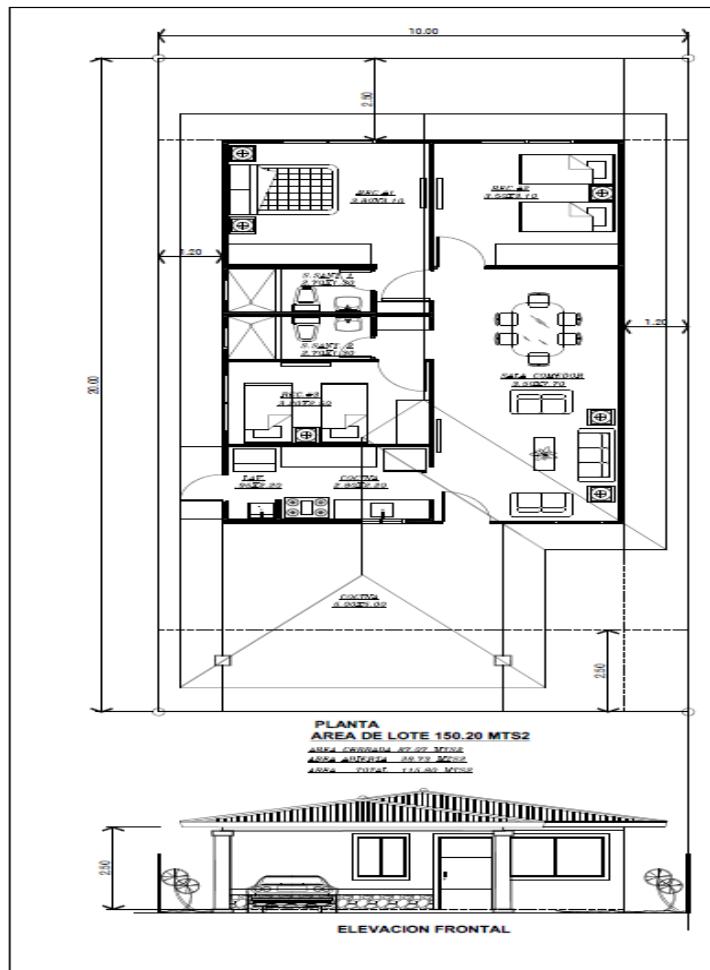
Vista de Plano de Casa Modelo del Proyecto Residencial
